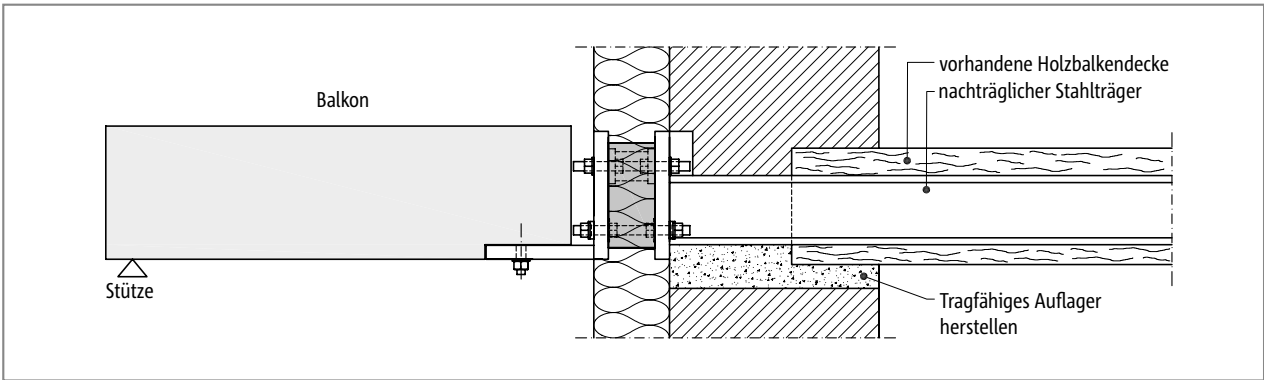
Schöck Isokorb® T Typ S: Fertigteilbalkon gestützt; angeschlossen an Holzbalkendecke
